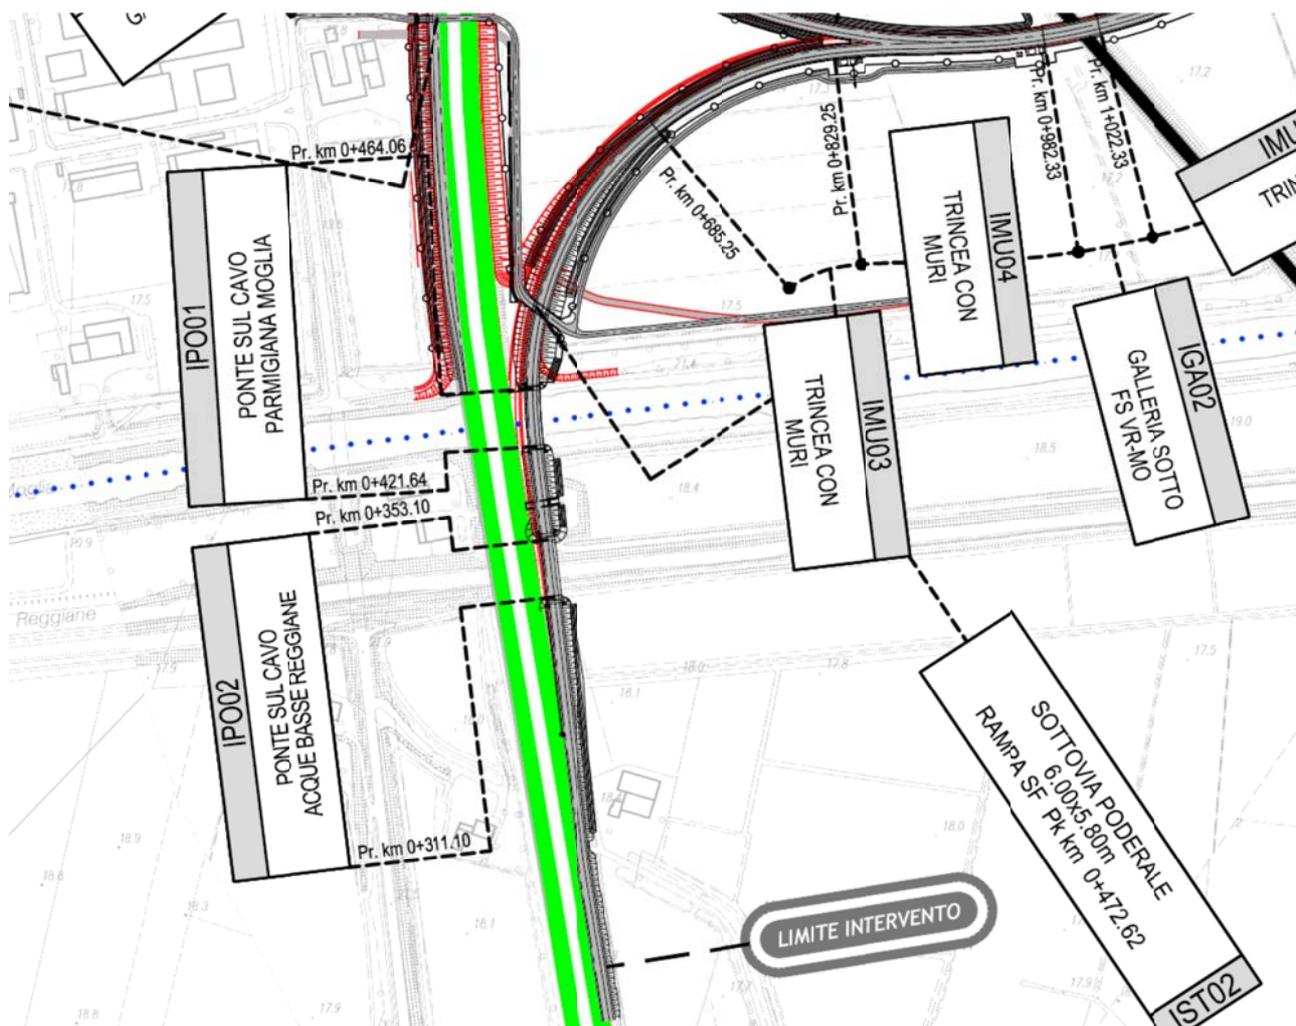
PLANIMETRIA ZONA SUD INTERCONNESSIONE CON A22
